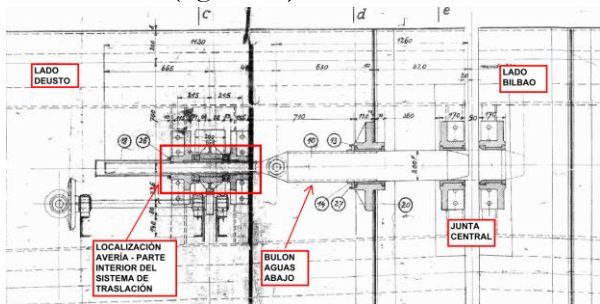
Bulón aguas abajo. Localización de la avería del sistema de accionamiento (vista en planta)
